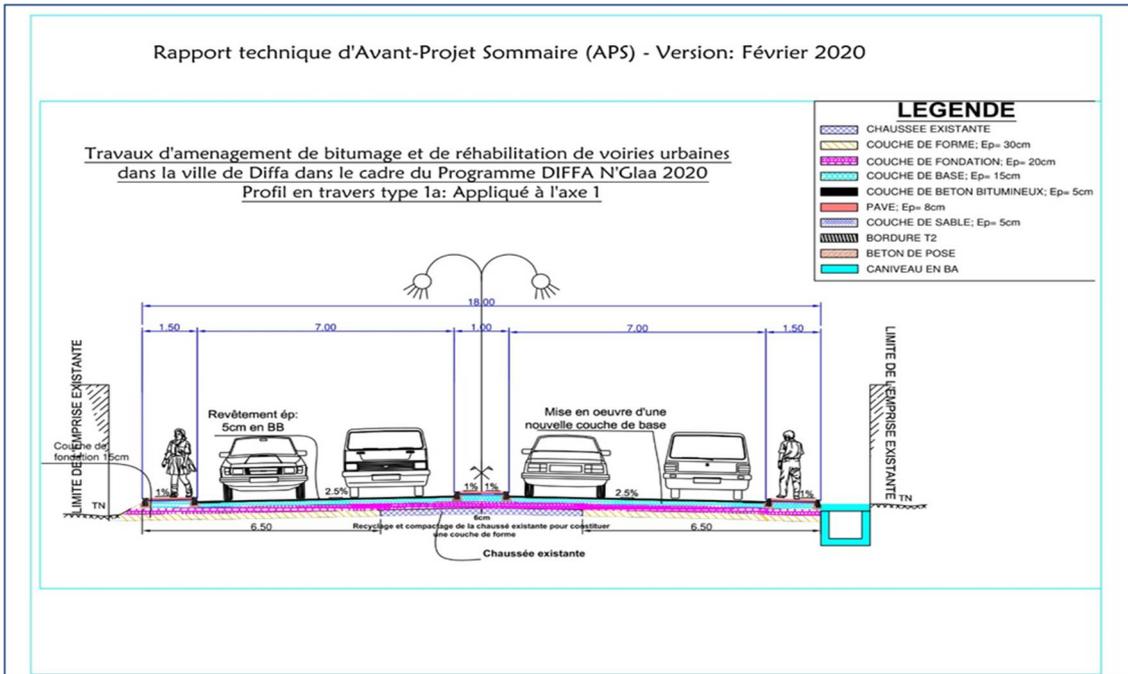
Profil en travers type 1a : Appliqué à l'axe 1
